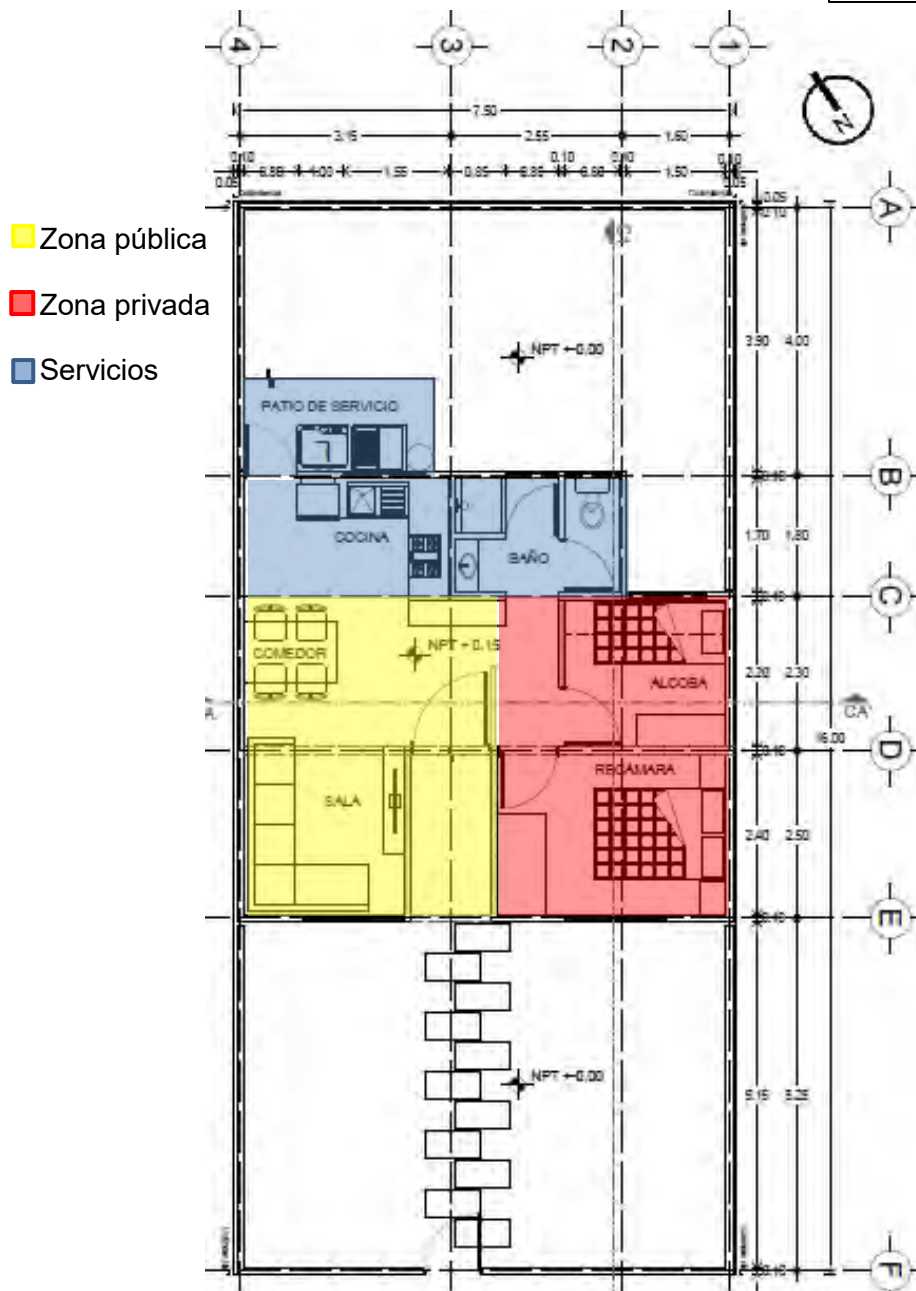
Planta arquitectónica de prototipo de vivienda B1. Primera etapa, planta baja.
